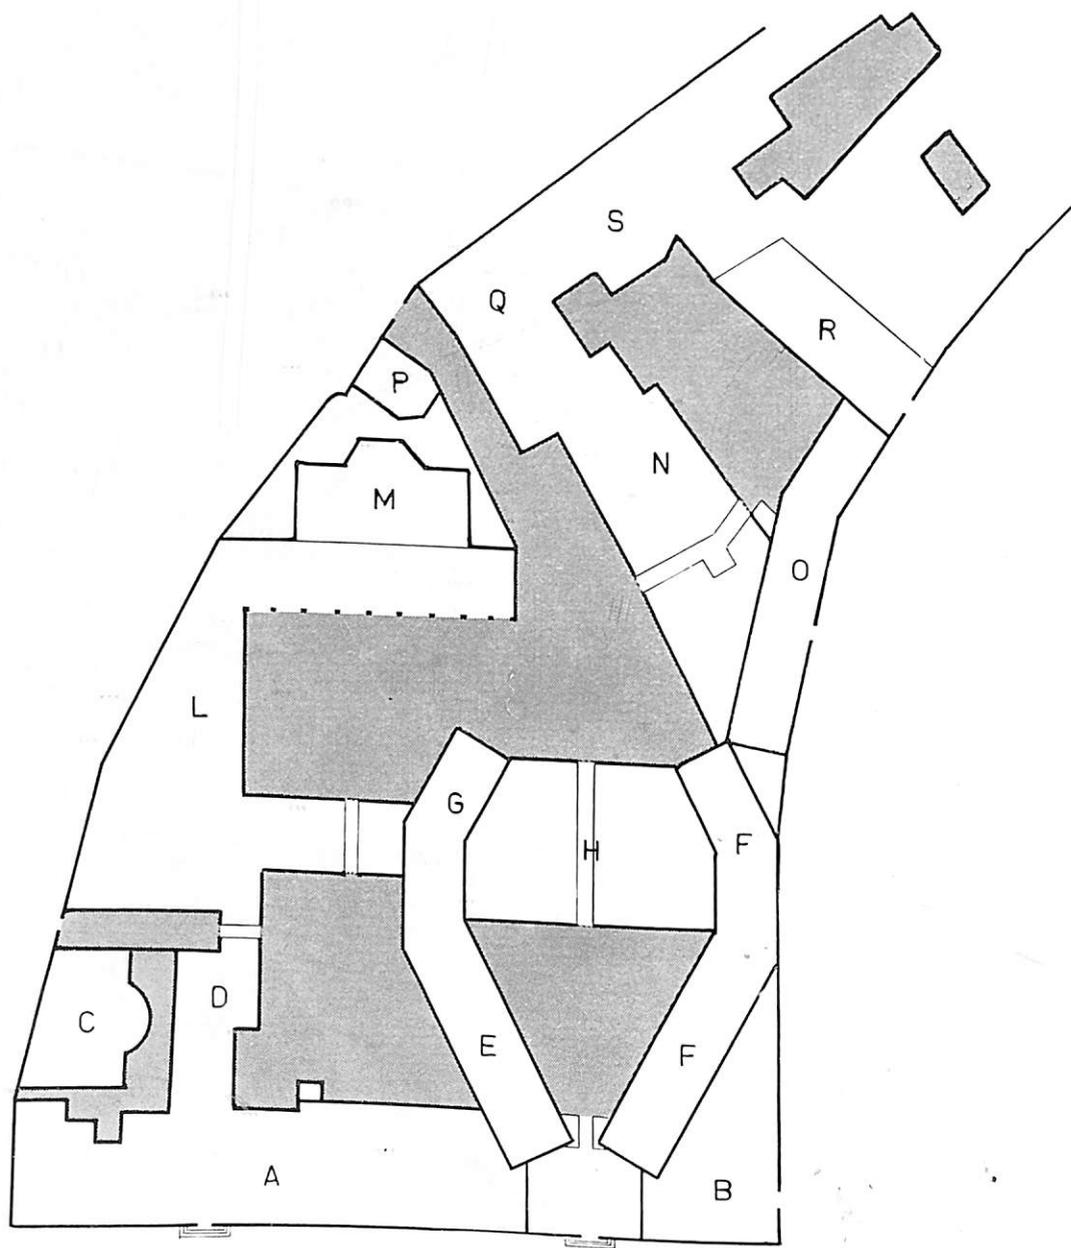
Pianta dell'area ospedaliera alla metà del XX secolo.
